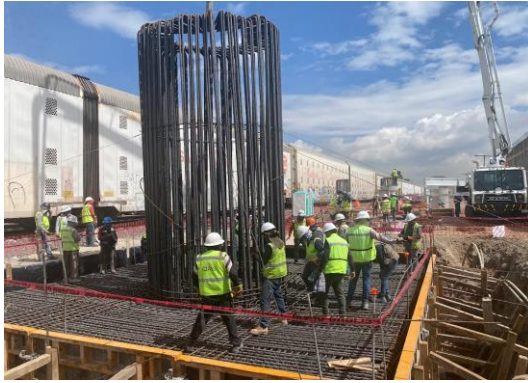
y 109 Autoría Propia (2023) "Vaciado y vibrado de concreto premezclado para zapata"
